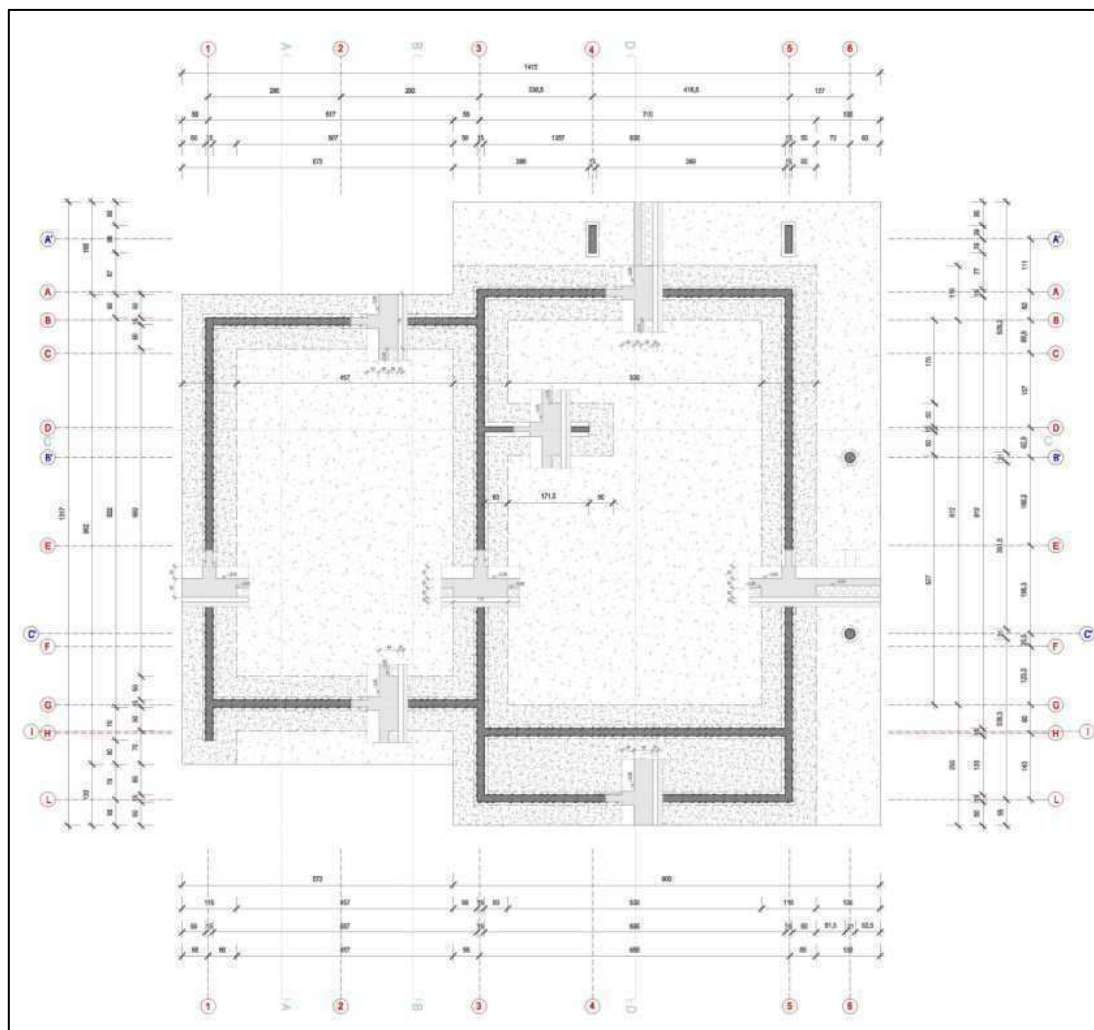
Pianta delle fondazioni a travi rovesce; Tavola 1.
